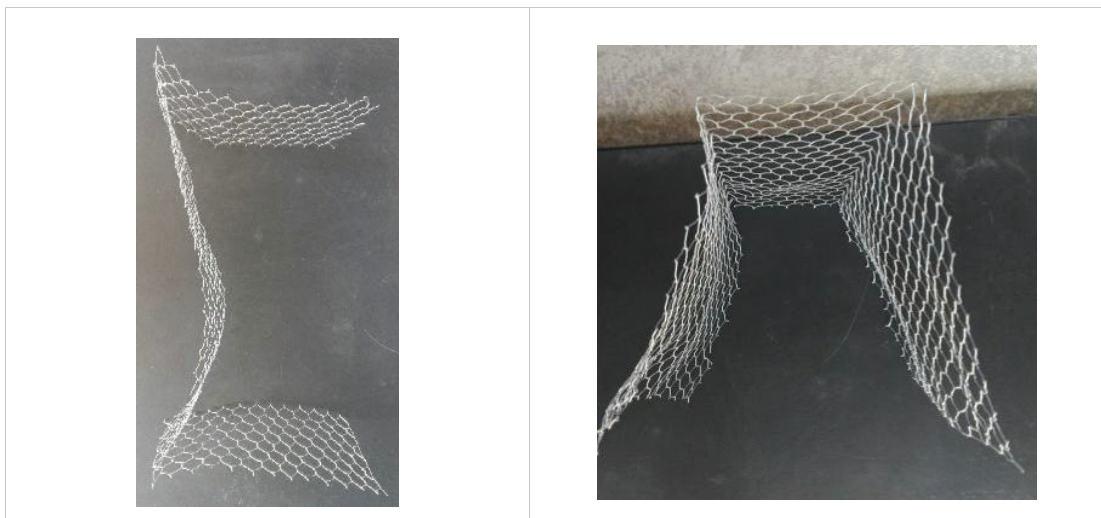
PIEZAS NECESARIAS PARA EL ARMADO DE UN CAJÓN DE MALLA
